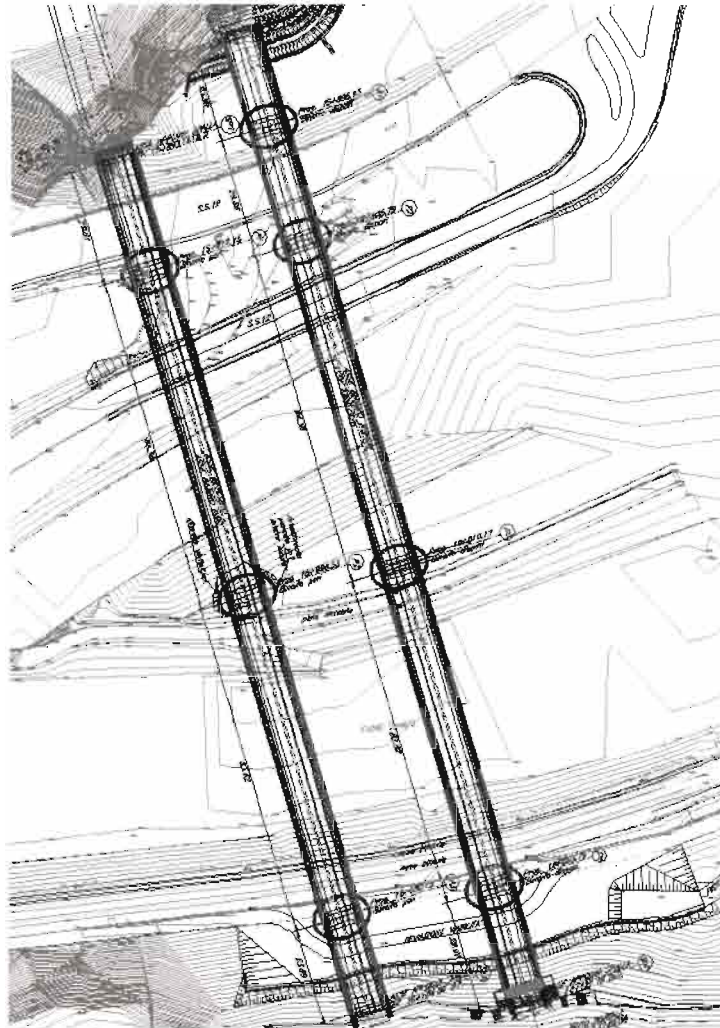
Ponte Fiume Isarco: Planimetria di progetto
